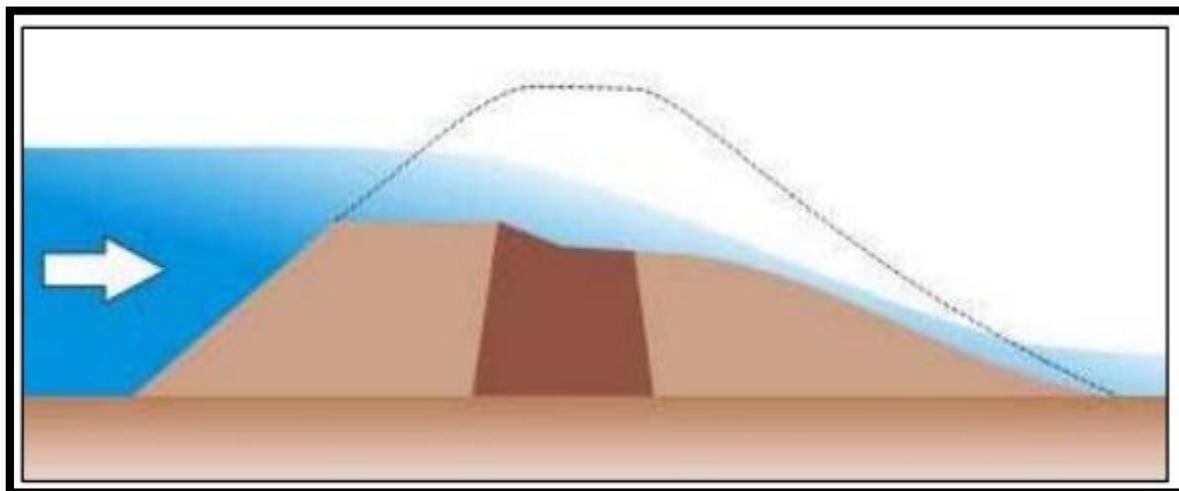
la submersion du barrage conduit à la rupture complète. (Arabtraining.com)
